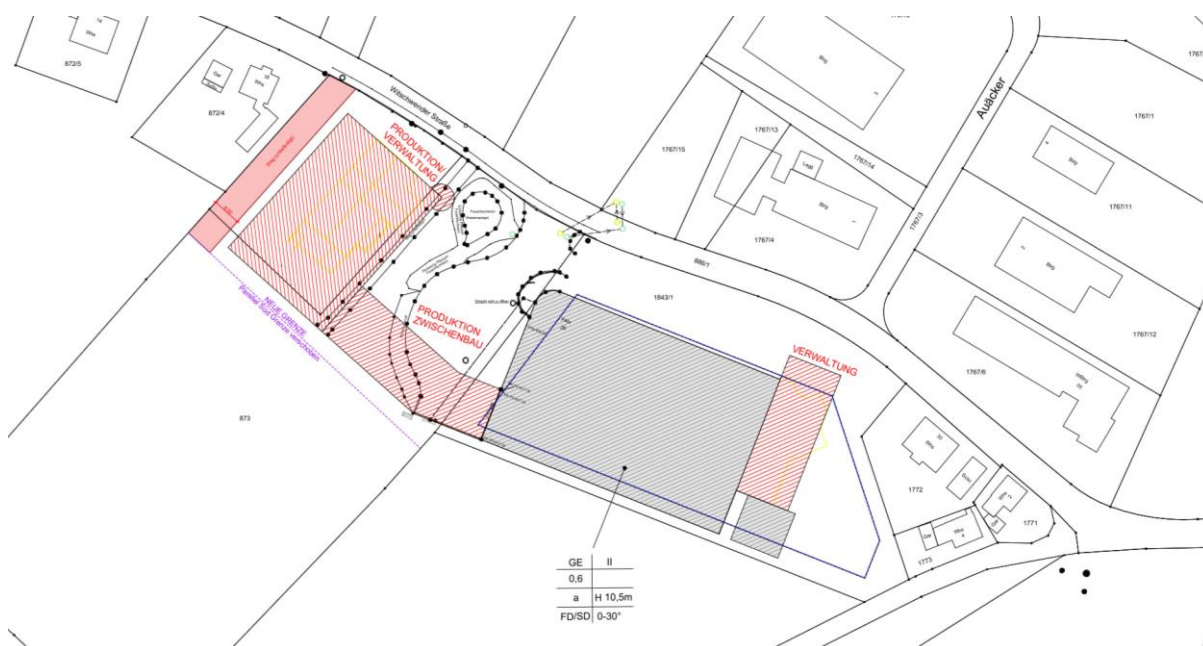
Lageplan Anbau und Erweiterung des bestehenden Verwaltungsgebäudes, ohne Maßstab (Quelle: daschmann planungsgesellschaft mbh, Stand: 24.02.2025)
